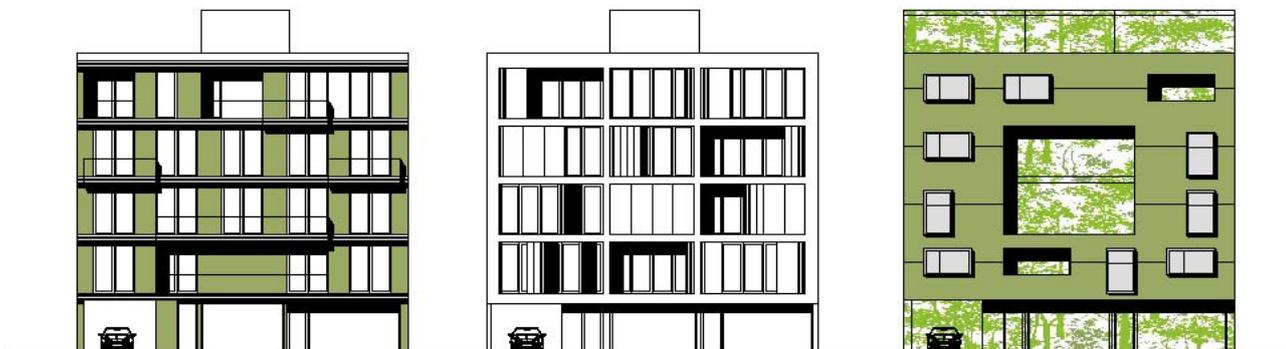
Flexible Fassaden vor flexiblen Grundrissen
